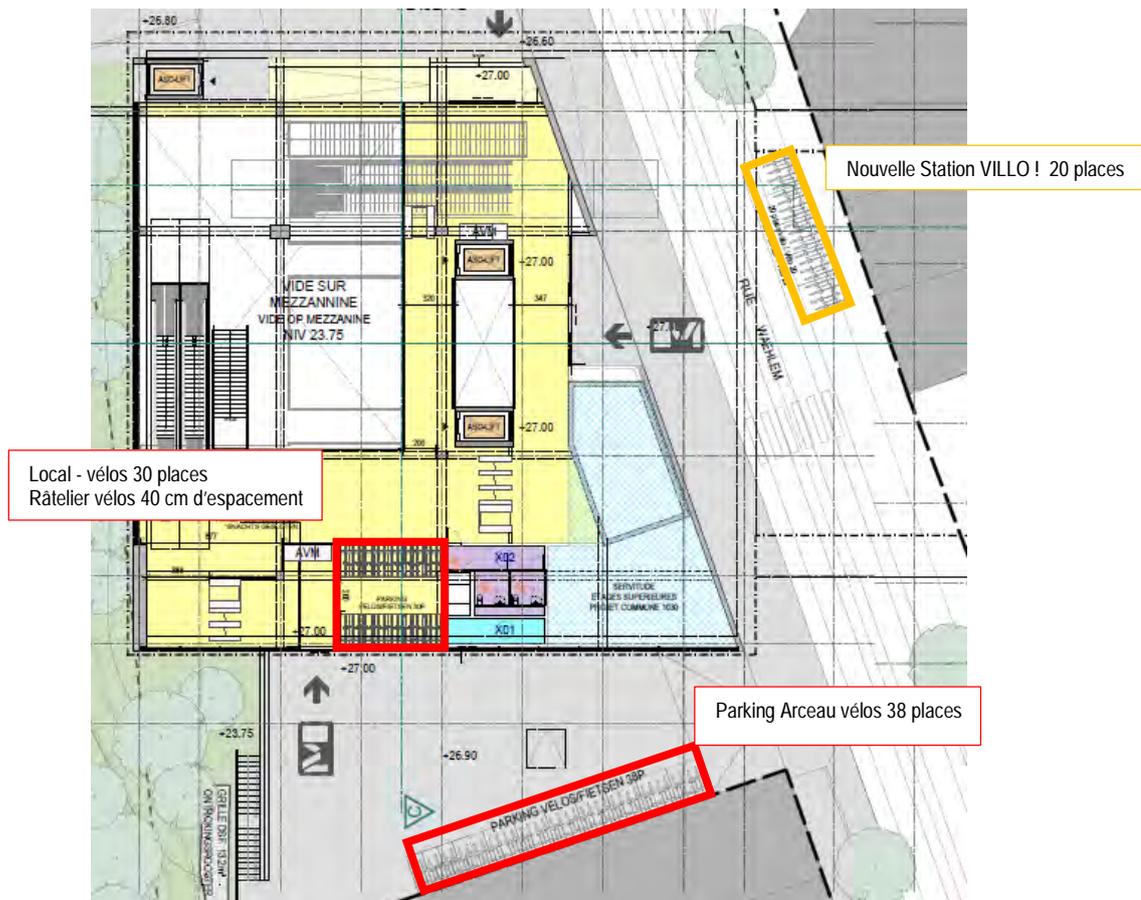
Localisation et détail du stationnement vélos et VILLO ! dans la boîte sud de la station (ARIES, 2020 sur fond BMN 2018)
